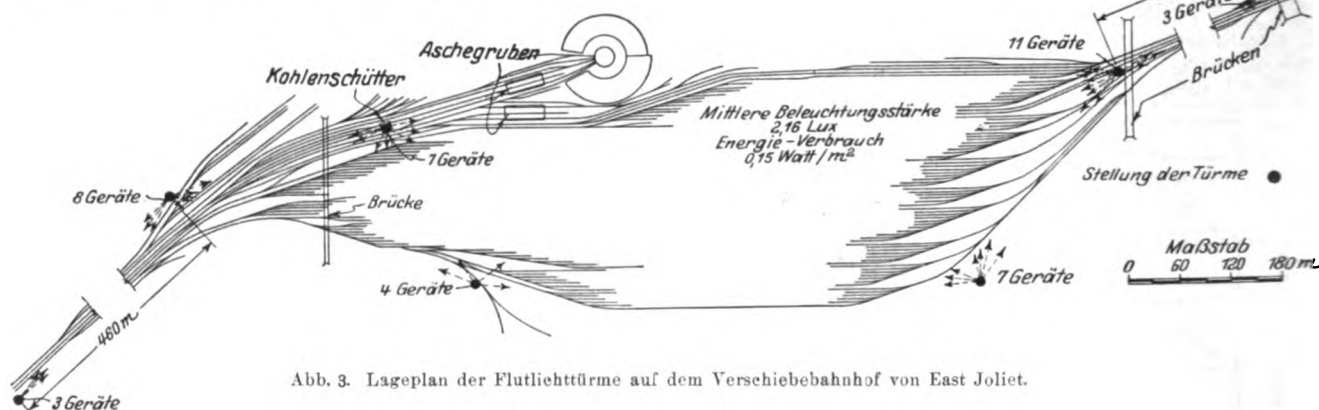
Lageplan der Flutlichttürme auf dem Verschiebebahnhof von East Joliet.
